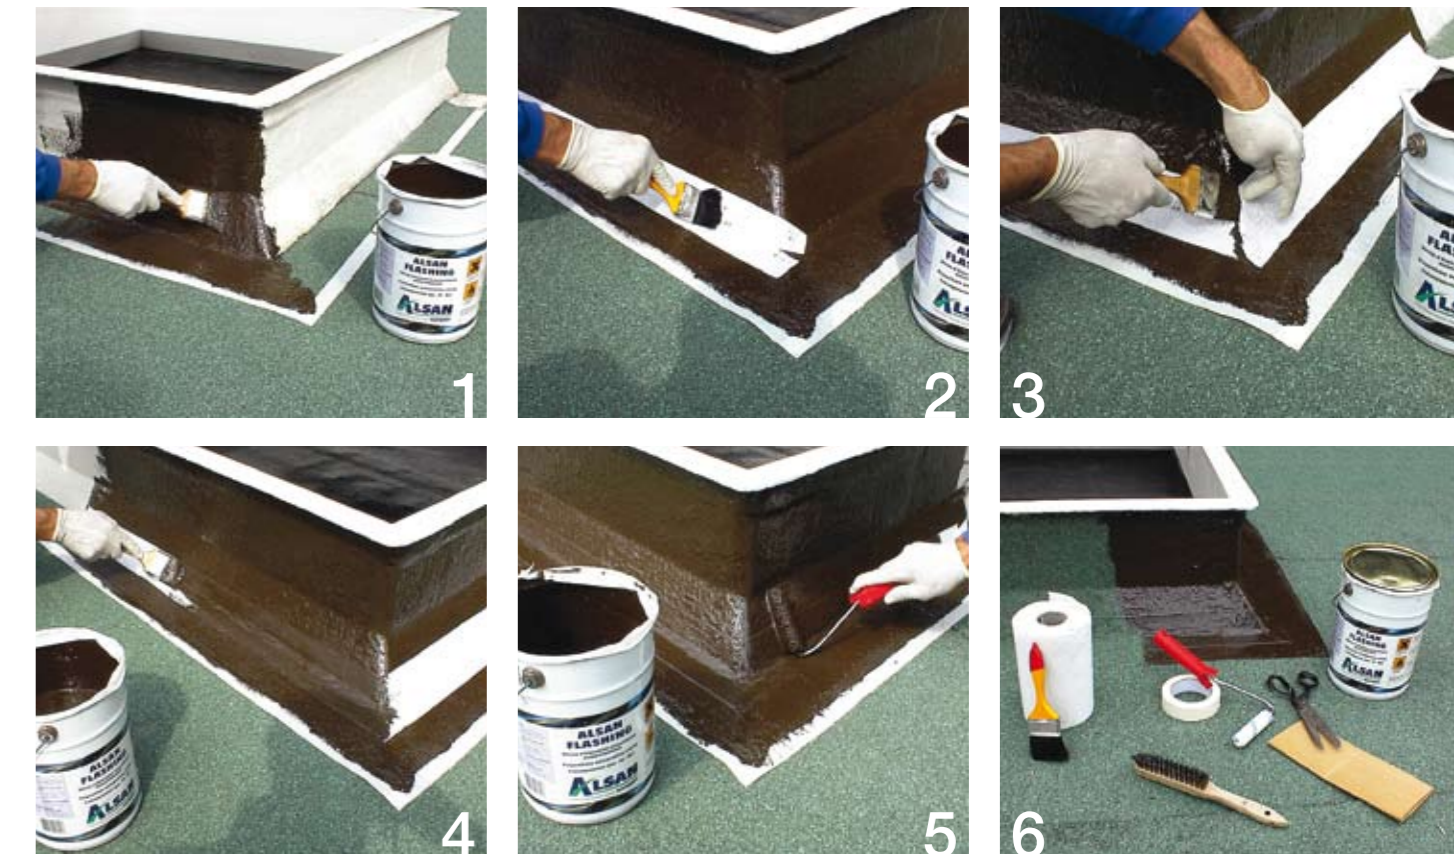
Alsan-Armierungseinlage mit der Alsan-Flüssigabdichtung überstreichen und in die erste Schicht einbetten.
